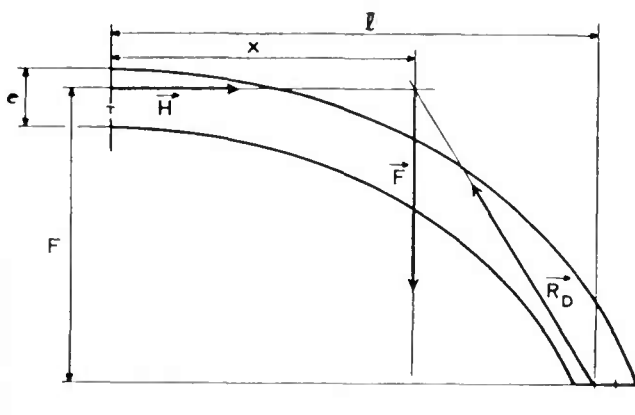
Détermination de la poussée horizontale à la clé.
